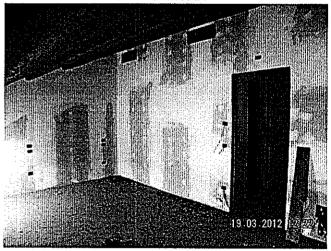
Stanza 2.6: Vista parete interna con porta accesso.
